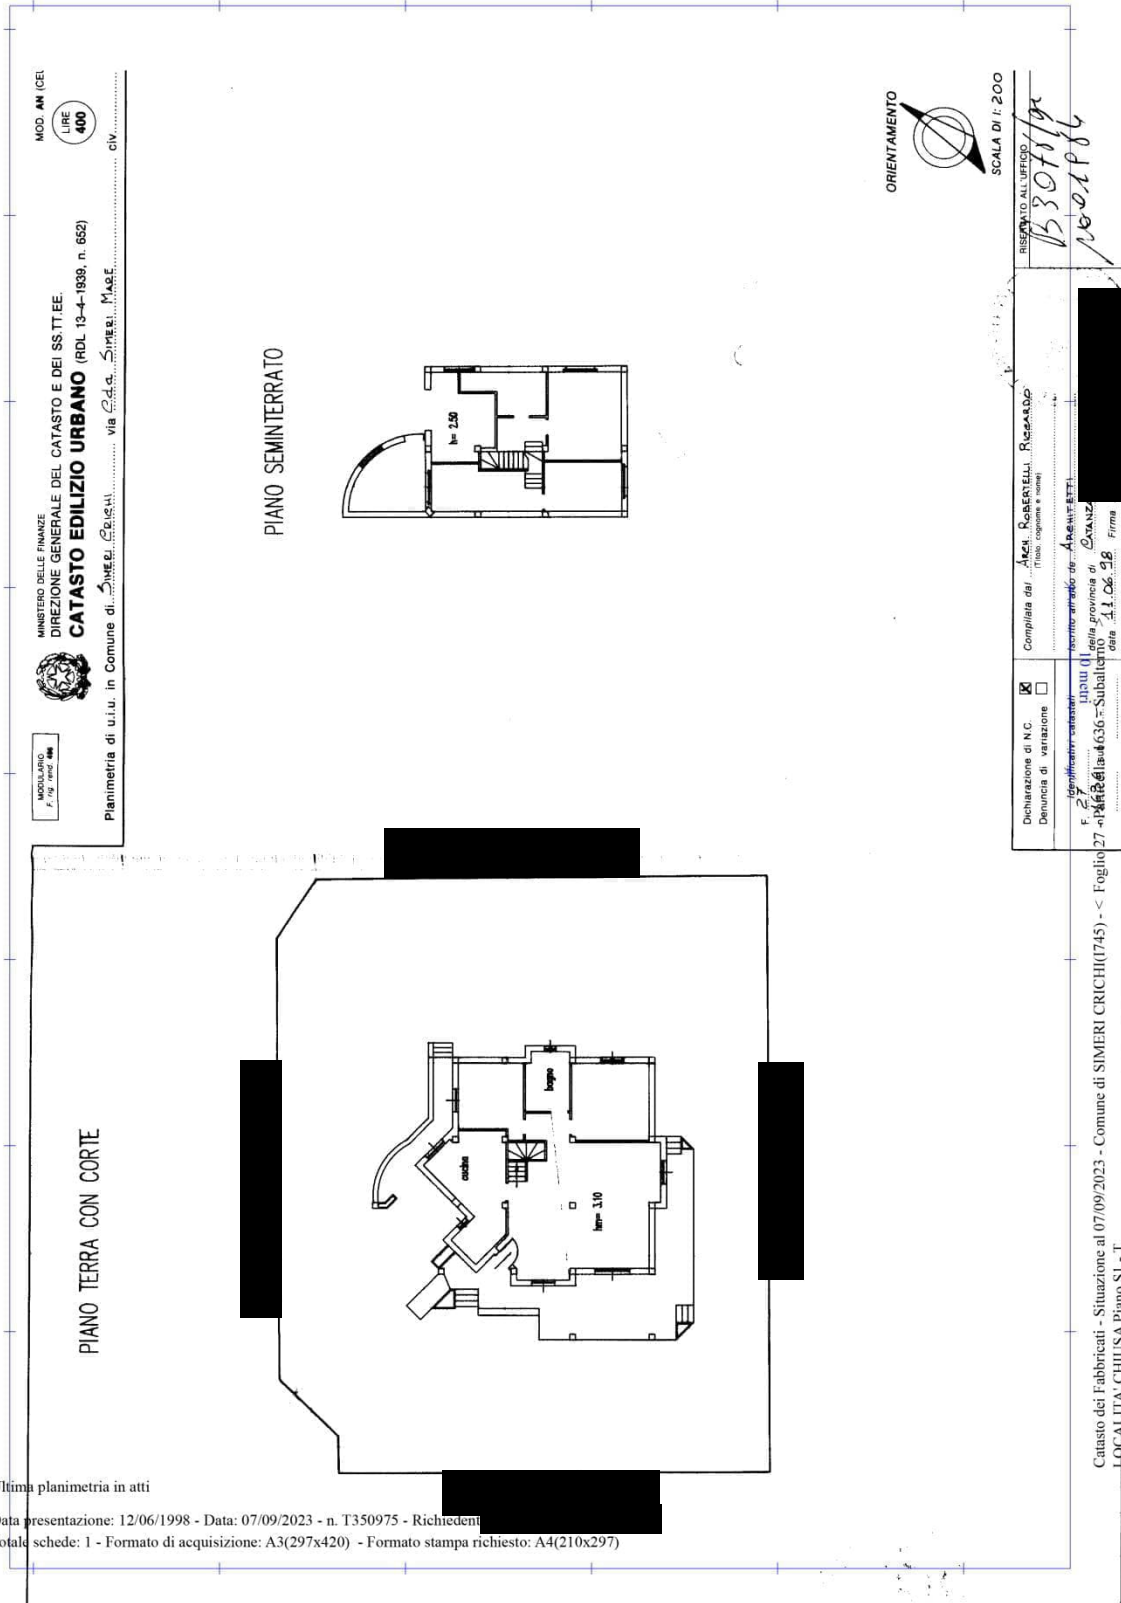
Ultima planimetria catastale in atti [ALL. 4]
